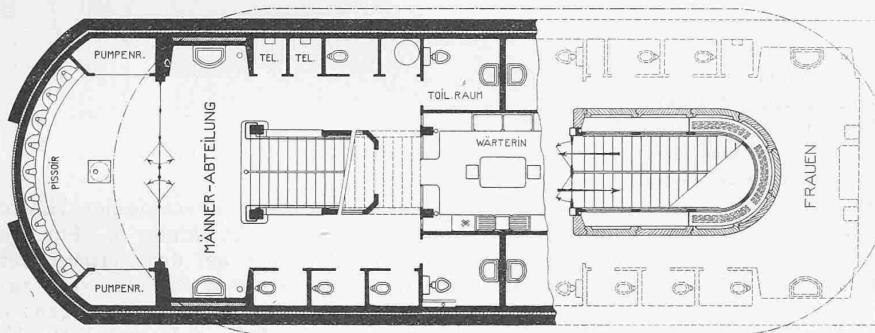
Grundrisse vom Untergeschoss und Obergeschoss, Maßstab 1:200.
